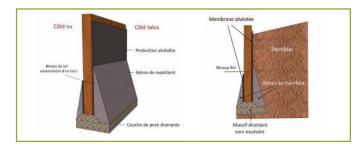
Schéma de principe de la construction d'un muret paysager de soutènement en bois (Dessin de Cédric Houel)
